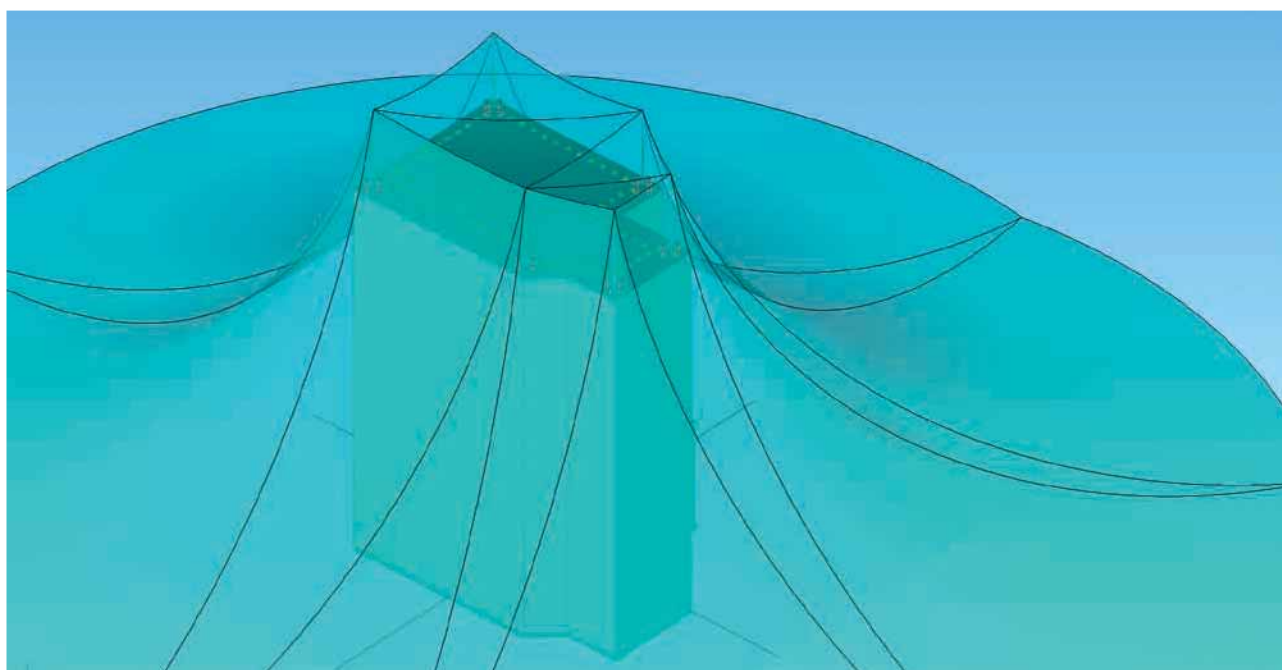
Model jímací soustavy podle ČSN EN 62305-3 ed. 2
